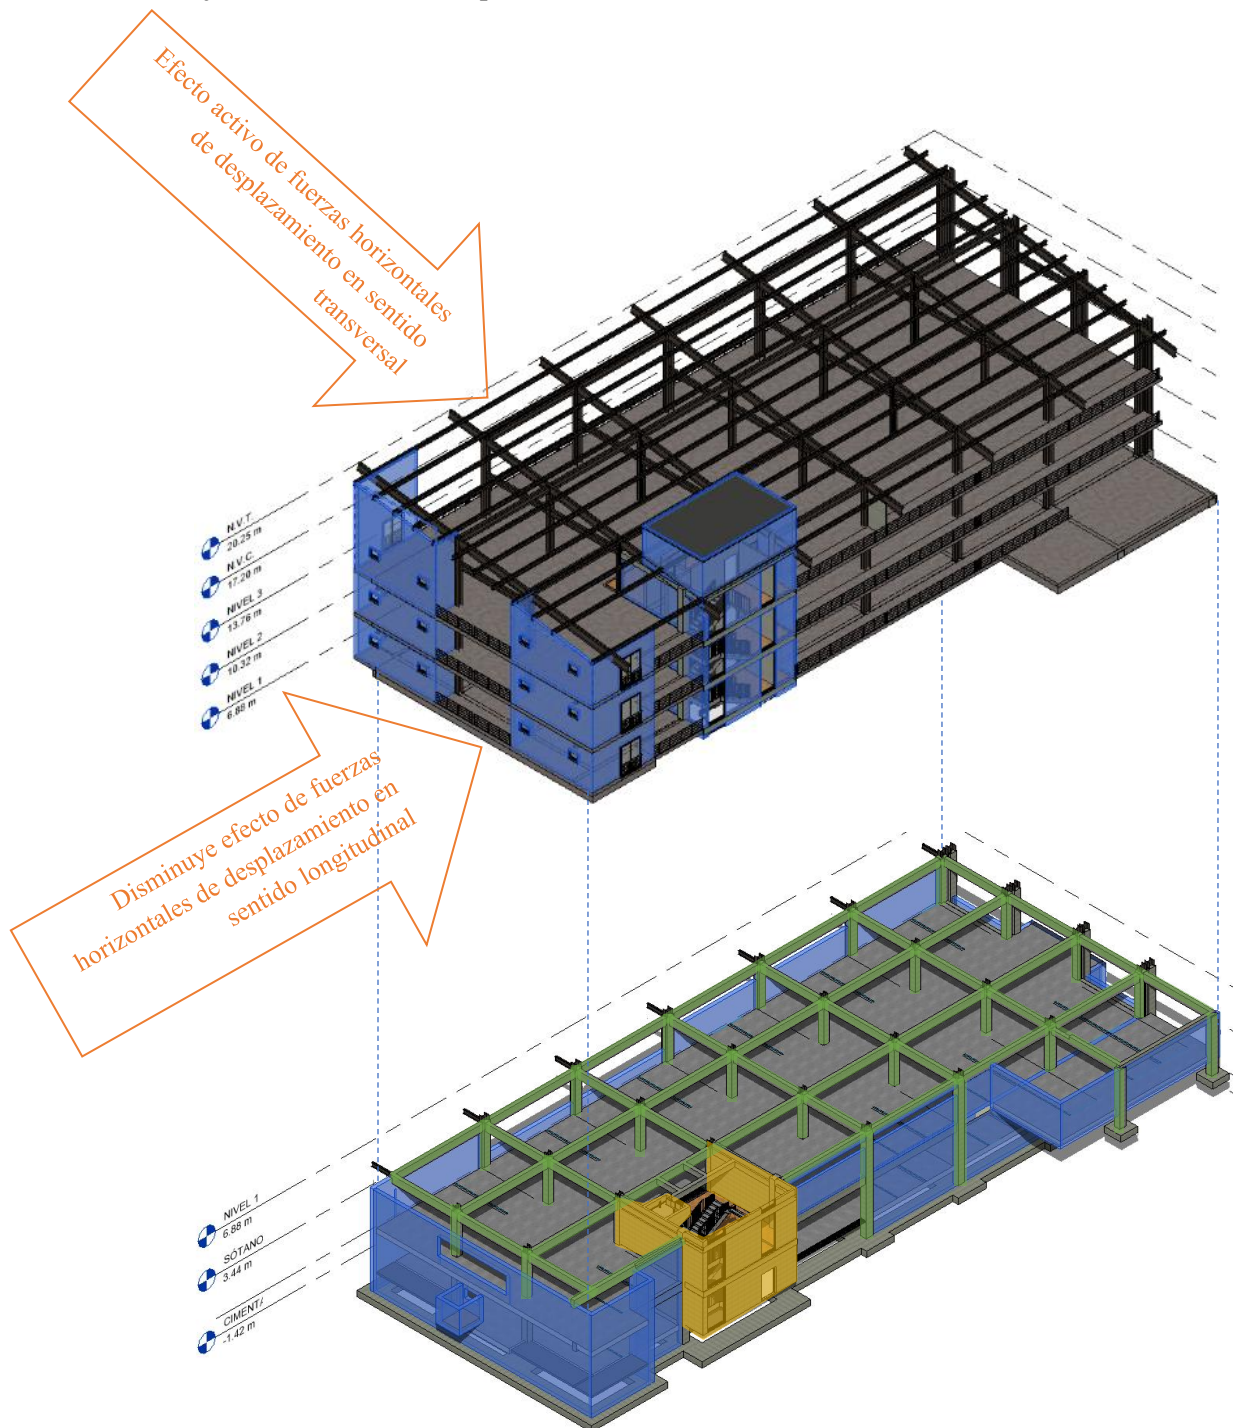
Muros de carga, columnas y vigas de concreto armado que se van a conservar en la nueva propuesta como elementos rigidizadores para disminuir la carga de desplazamiento horizontal. Fuente: Elaboración propia
